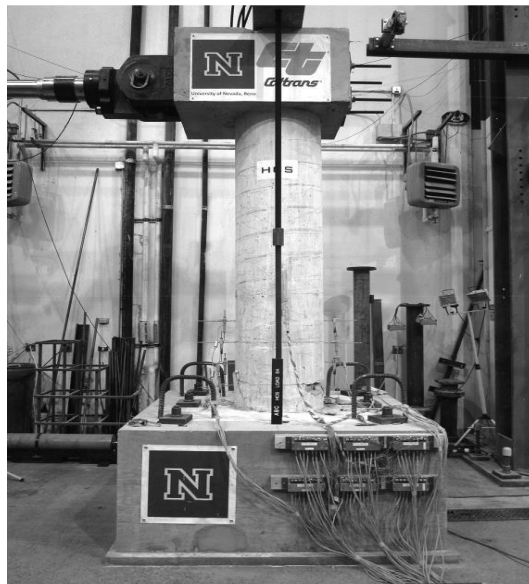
Columna de concreto reforzado sometida a carga axial constante y carga lateral (Tazarv *et al.*, 2016)
